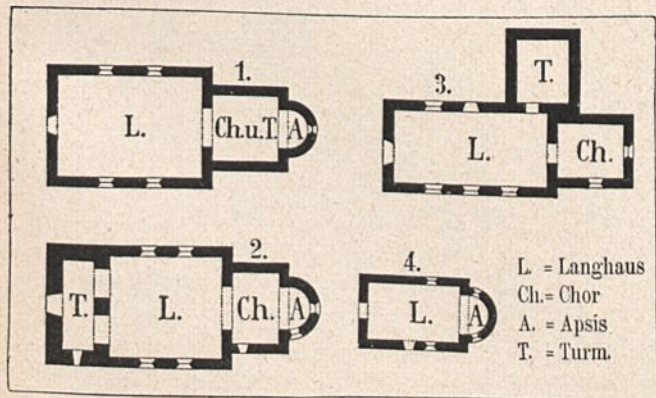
Grundrisse von Dorfkirchen.
